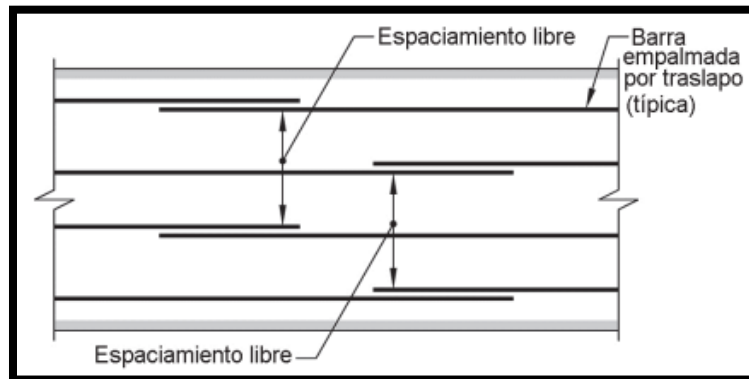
Espaciamiento libre para traslapes del acero de refuerzo (ACI 318-14, Capítulo 25, Sección 25.5, Fig. R25.5.2.1)
